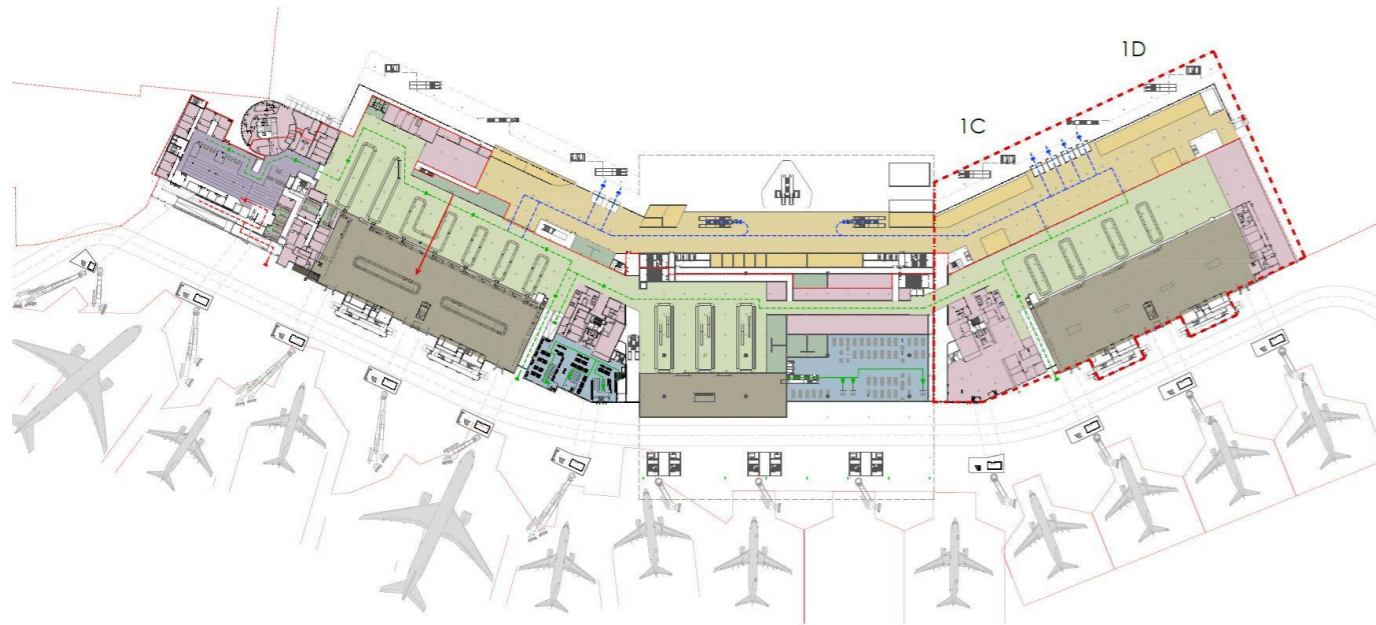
Fase 2 – Interventi terminal C, pianta livello arrivi
